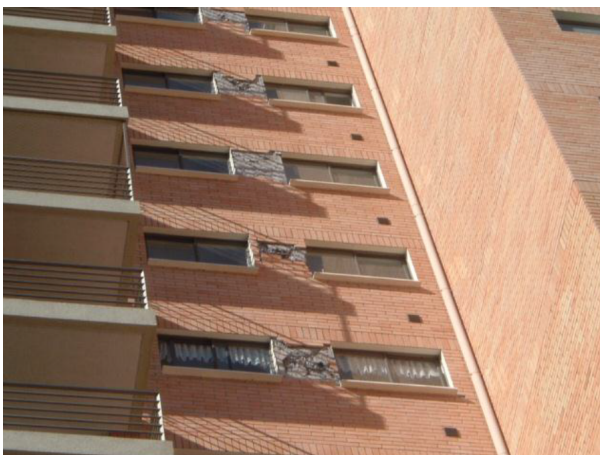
Aplastamiento del hormigón del muro de eje 17.
